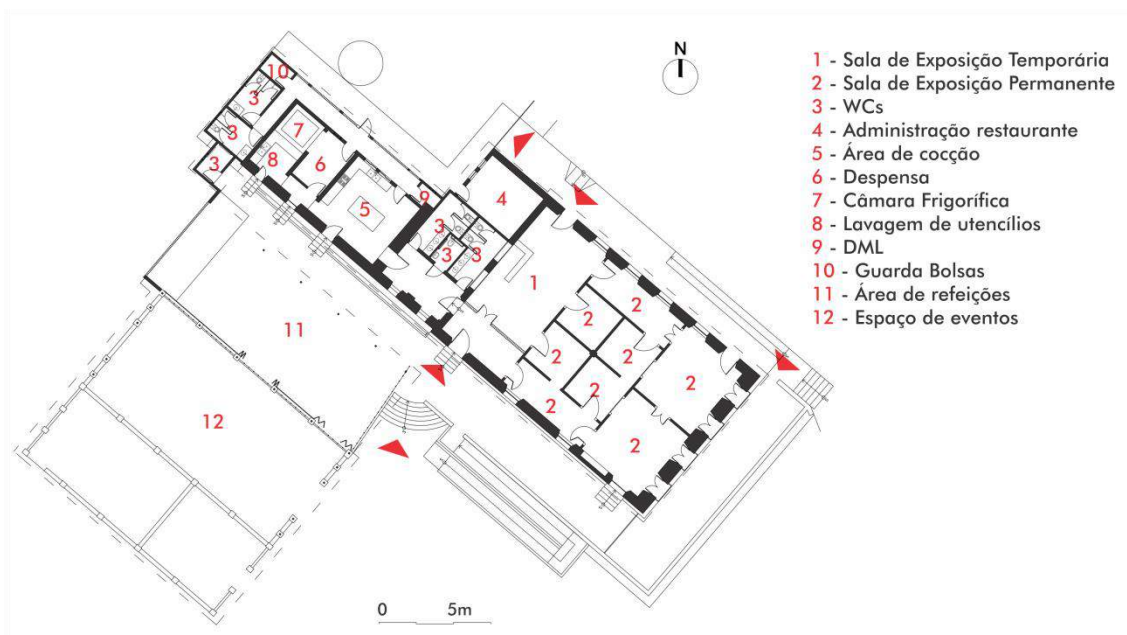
Planta baixa final da proposta – Casa-grande e Casa de bagaço.
